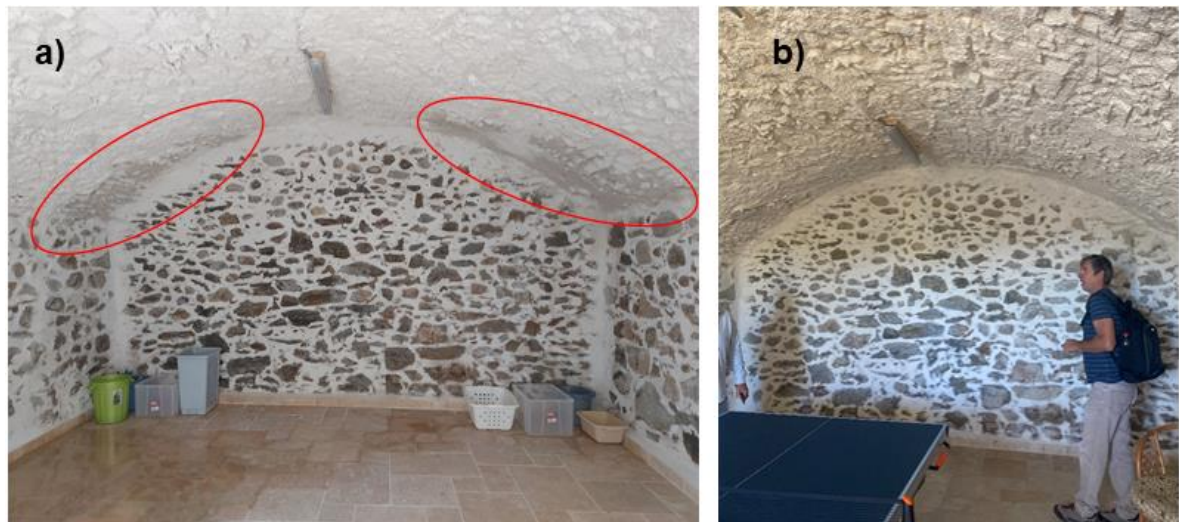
N°13 rue sous les fenêtres : a) Salle de jeux pendant l'infiltration, eau venue du fond de la voute et du mur maçonné, b) salle de jeux pendant la visite.
